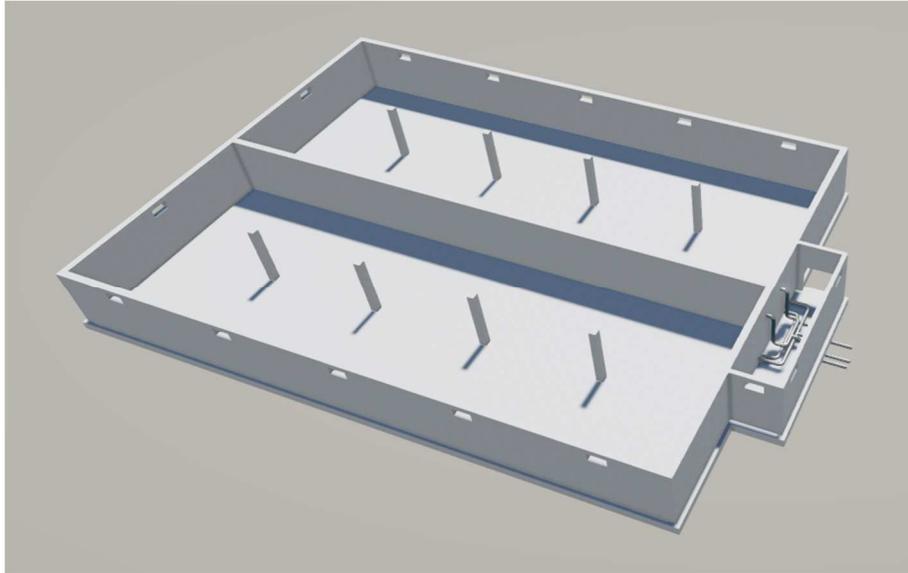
Perspectiva 3D del depósito sin cubierta
